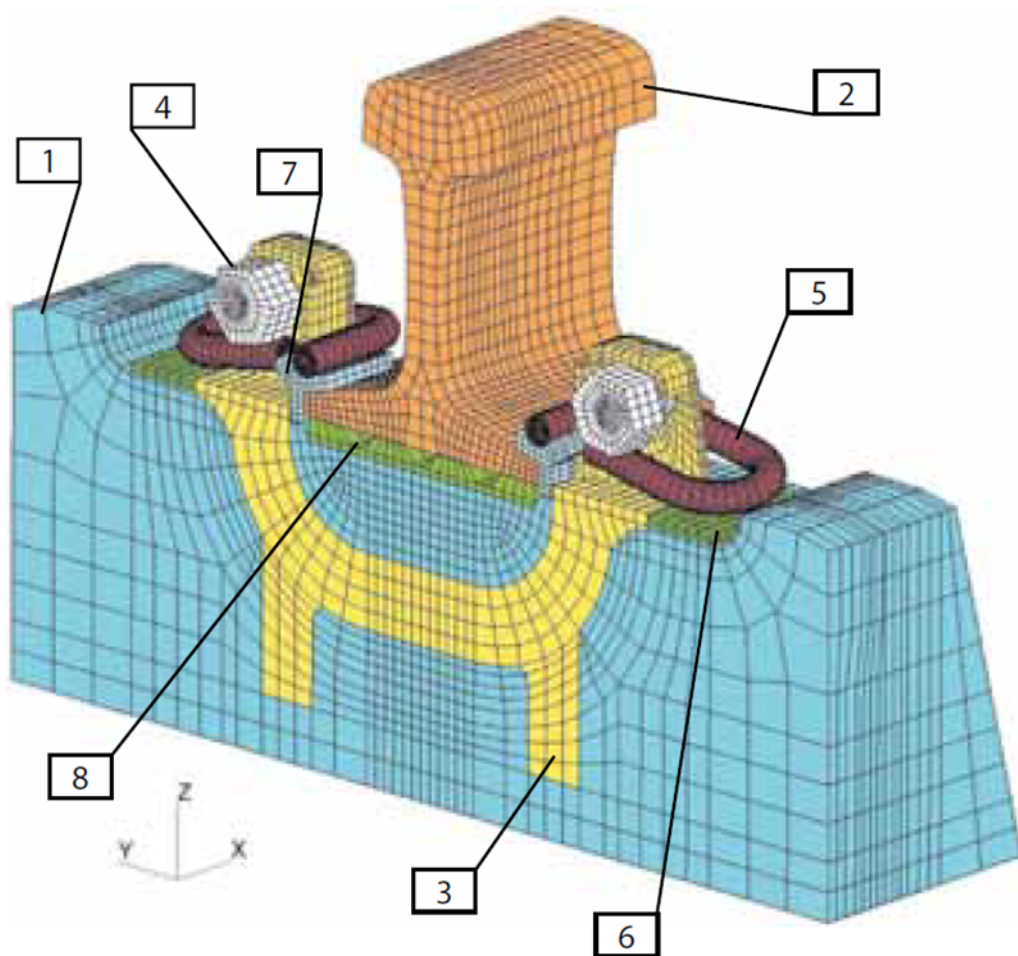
Промежуточные рельсовые крепления АРС: 1 – железобетонная шпала; 2 – рельс; 3 – анкер; 4 – монорегулятор; 5 - клемма; 6 – подклемник; 7 – уголок изолирующий; 8 – прокладка.
